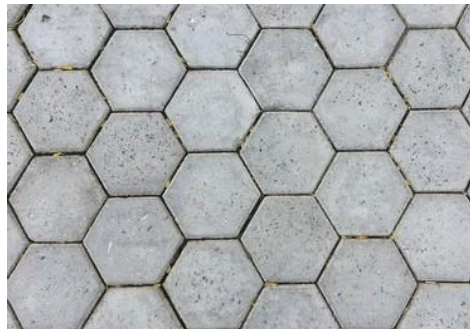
Ladrilhamento hexagonal em pavimentação de calçada.
